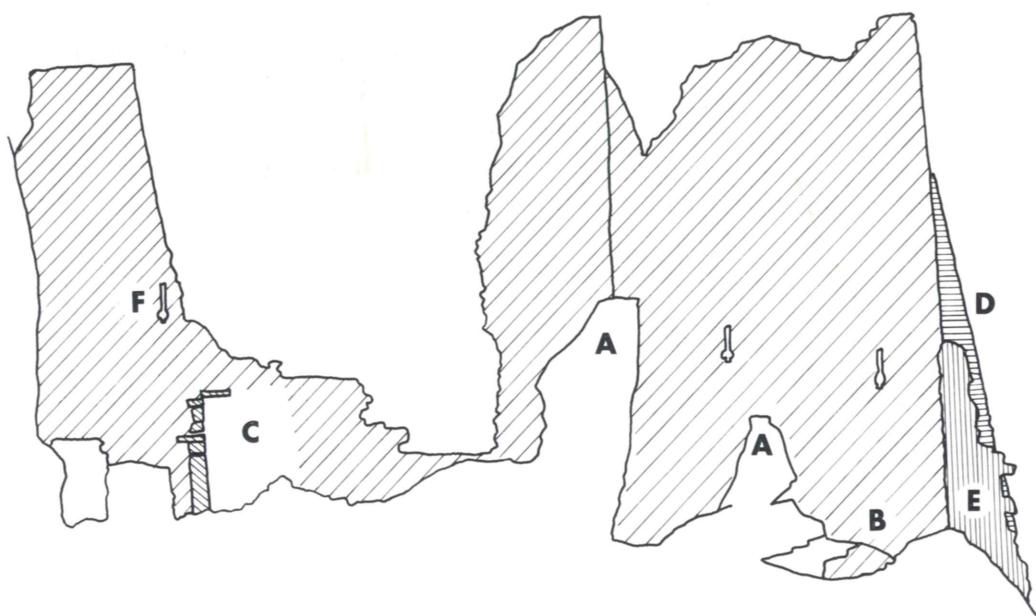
Schema muro di cinta superiore, facciata nord; particolare F, vedi anche fig. 9, n. 2 (Dis. M. Avanzini).
